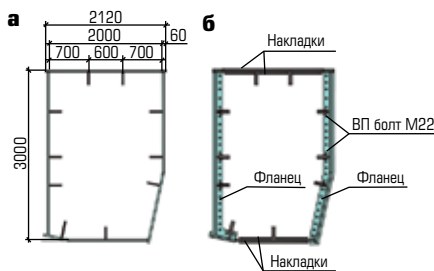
Поперечное сечение арочного свода (а) и монтажный стык (б)
